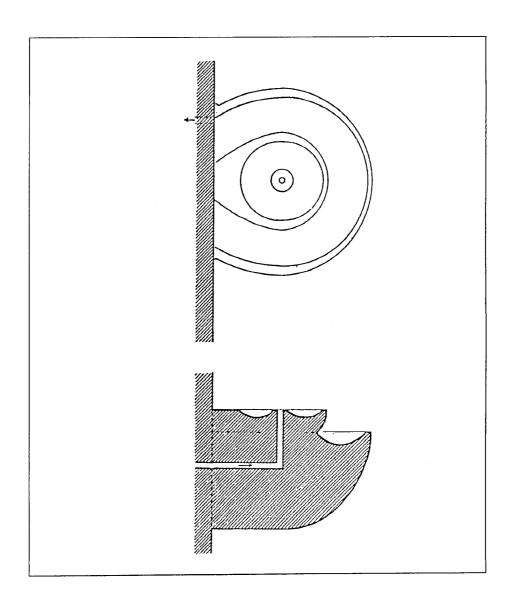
مسقط أفقي وقطاع لتربة خليل باشا الملحقة بمسجده في بانيا لوكا (عن :Pašić) .
